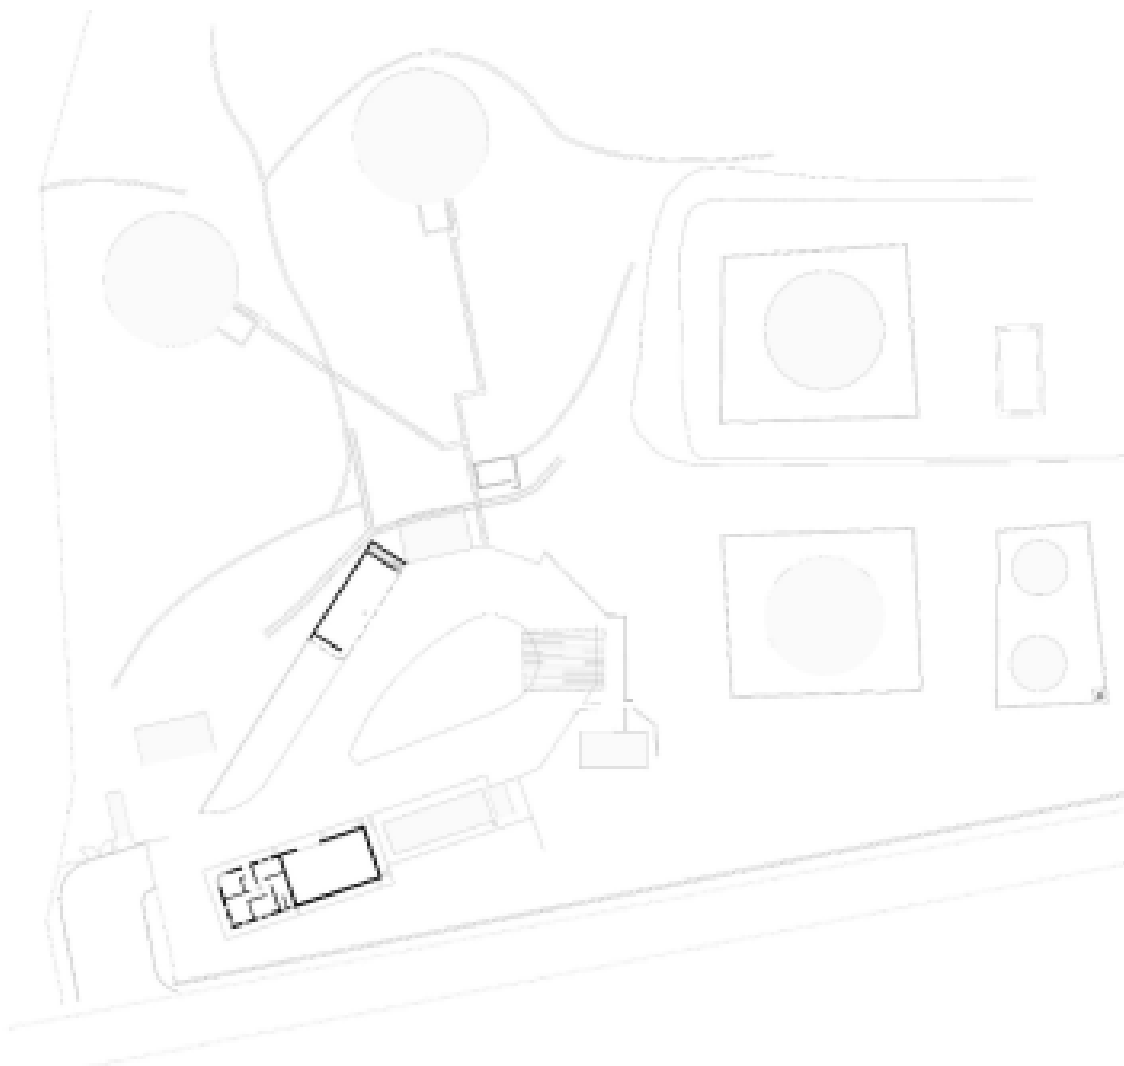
Planta do proposto no conjunto: Telheiro a Norte e edifício Portaria/armazém a Sul. (Ilustração nossa, 2017).
